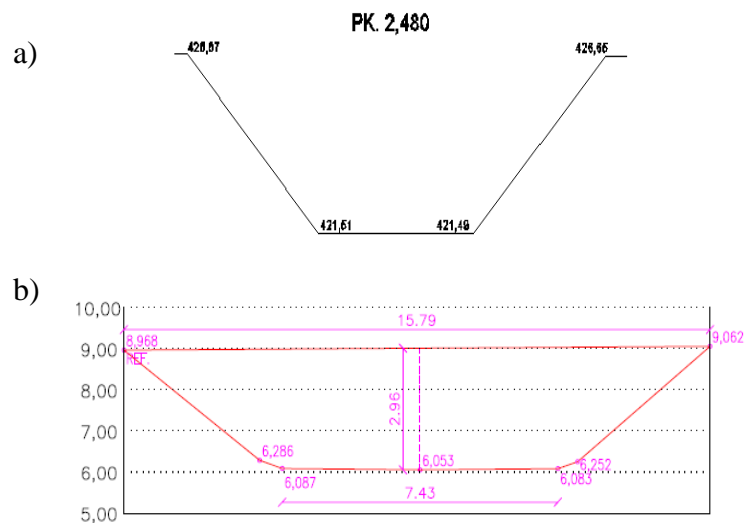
Comparación de secciones 1 a) Sección en el canal de Gavet de la Conca b) Sección en el canal de la derecha del Ebro
